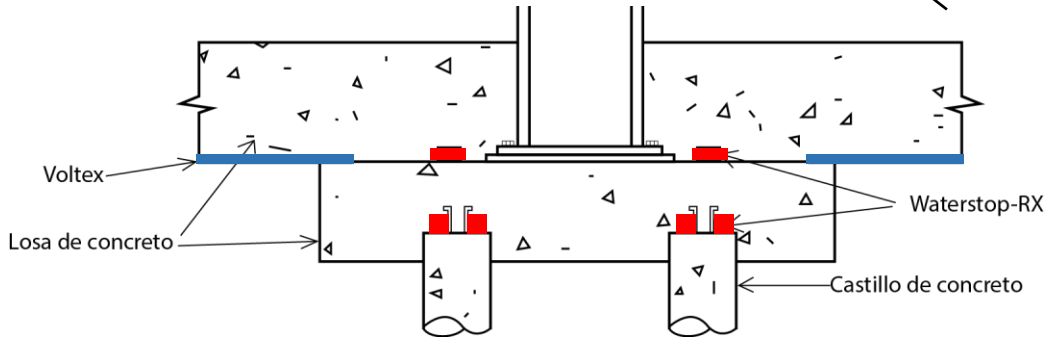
Losa tapa de pilotes (sin carga hidráulica).
